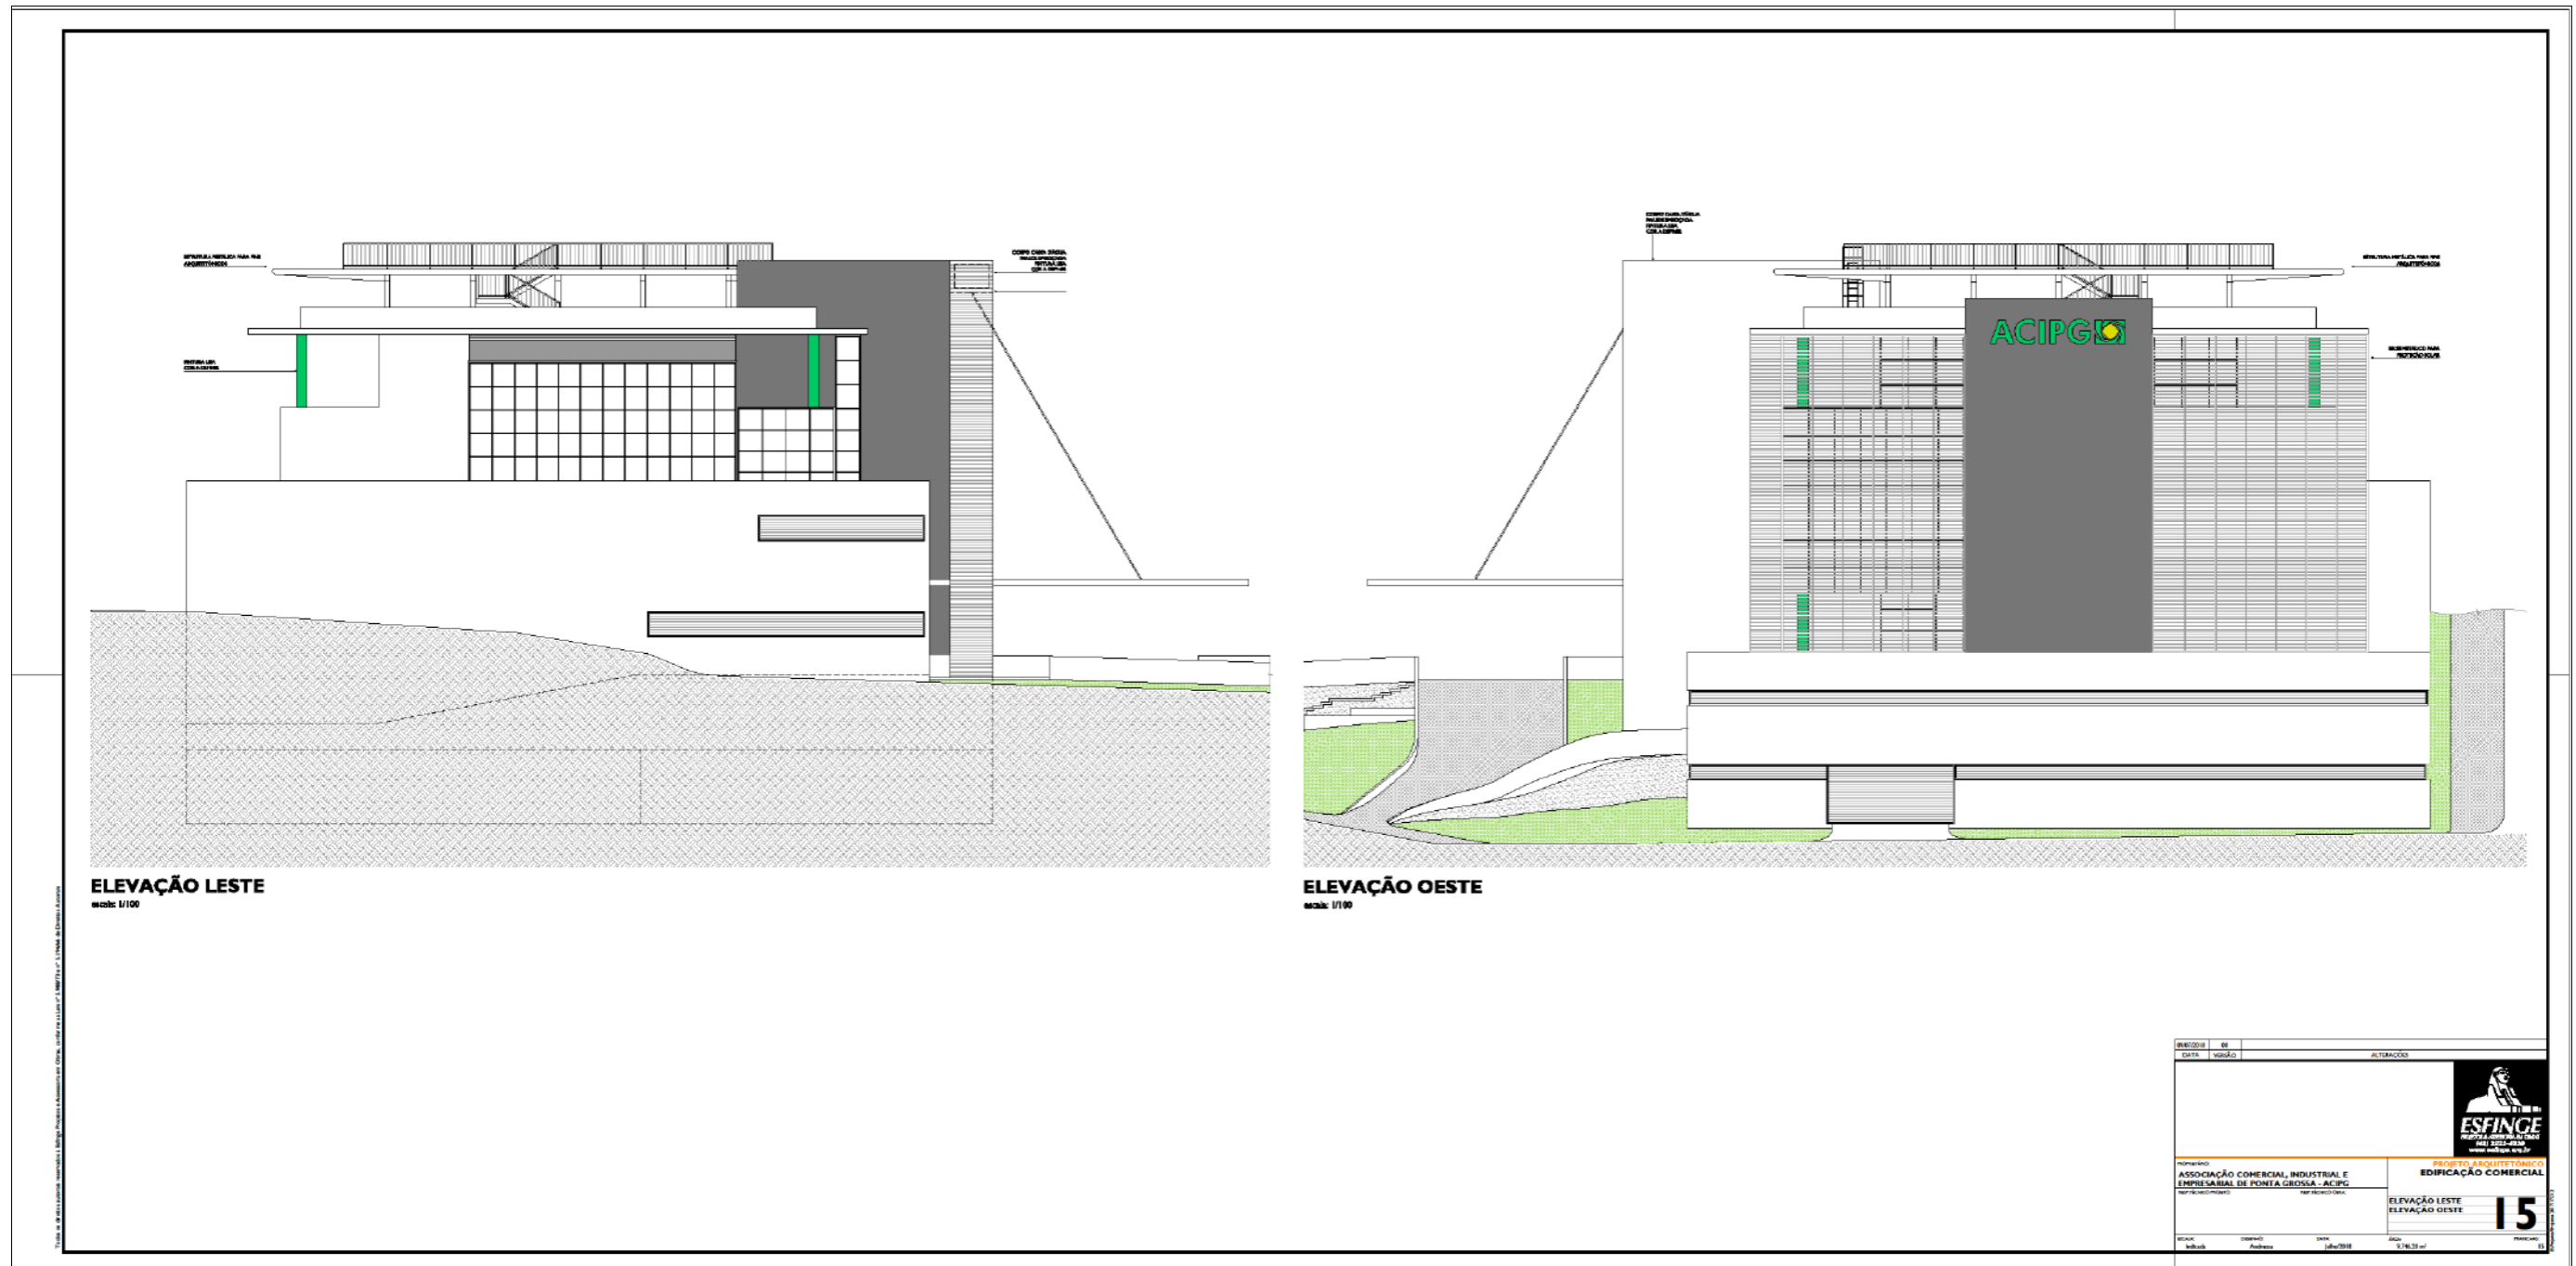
Elevação Leste e Oeste. Fonte: Esfinge Arquitetura e Engenharia (2018).
